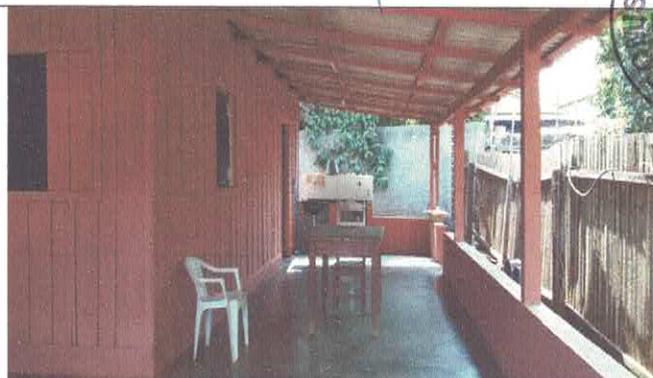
fachada lateral. Piso cimentado, sem forro em vários ambientes fazem o padrão de acabamento da edificação ser caracterizado baixo.
